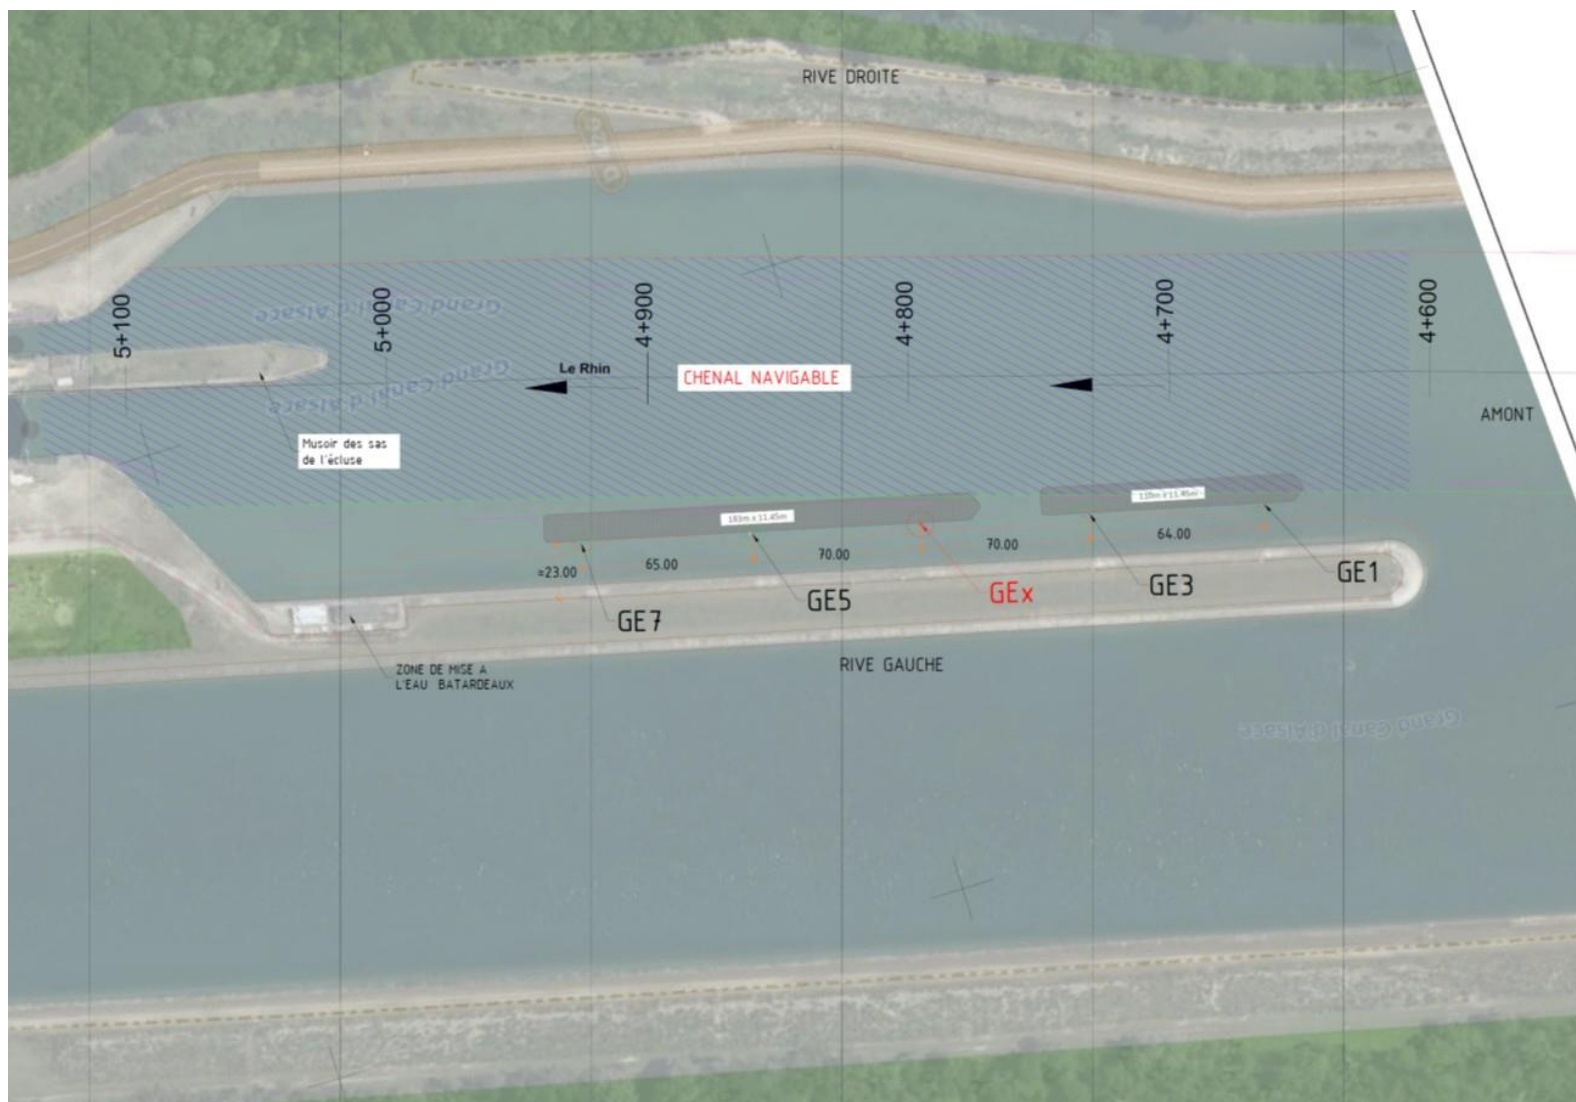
Vue en plan de l'implantation du nouveau duc d'Albe - Garage amont de l'écluse de Gerstheim
